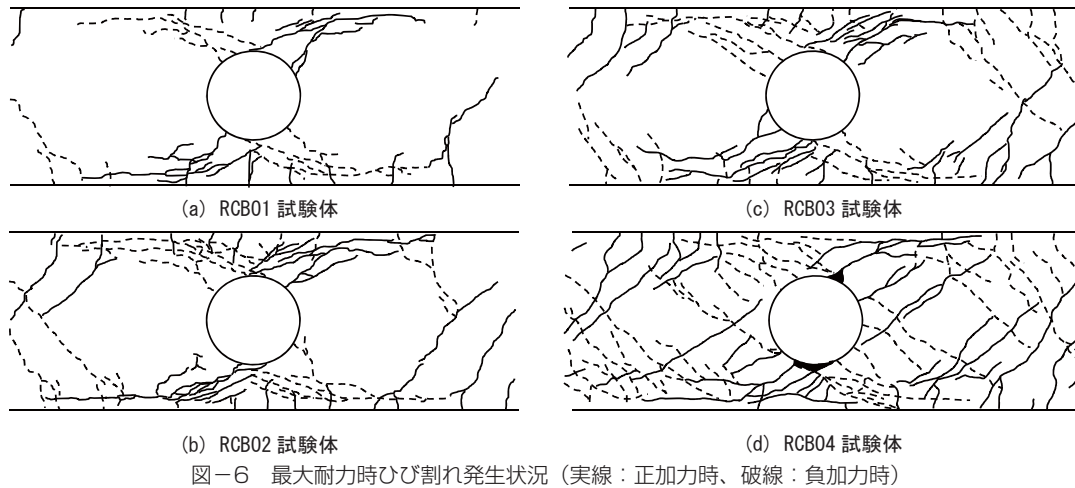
最大耐力時ひび割れ発生状況 (実線：正加力時、破線：負加力時)
